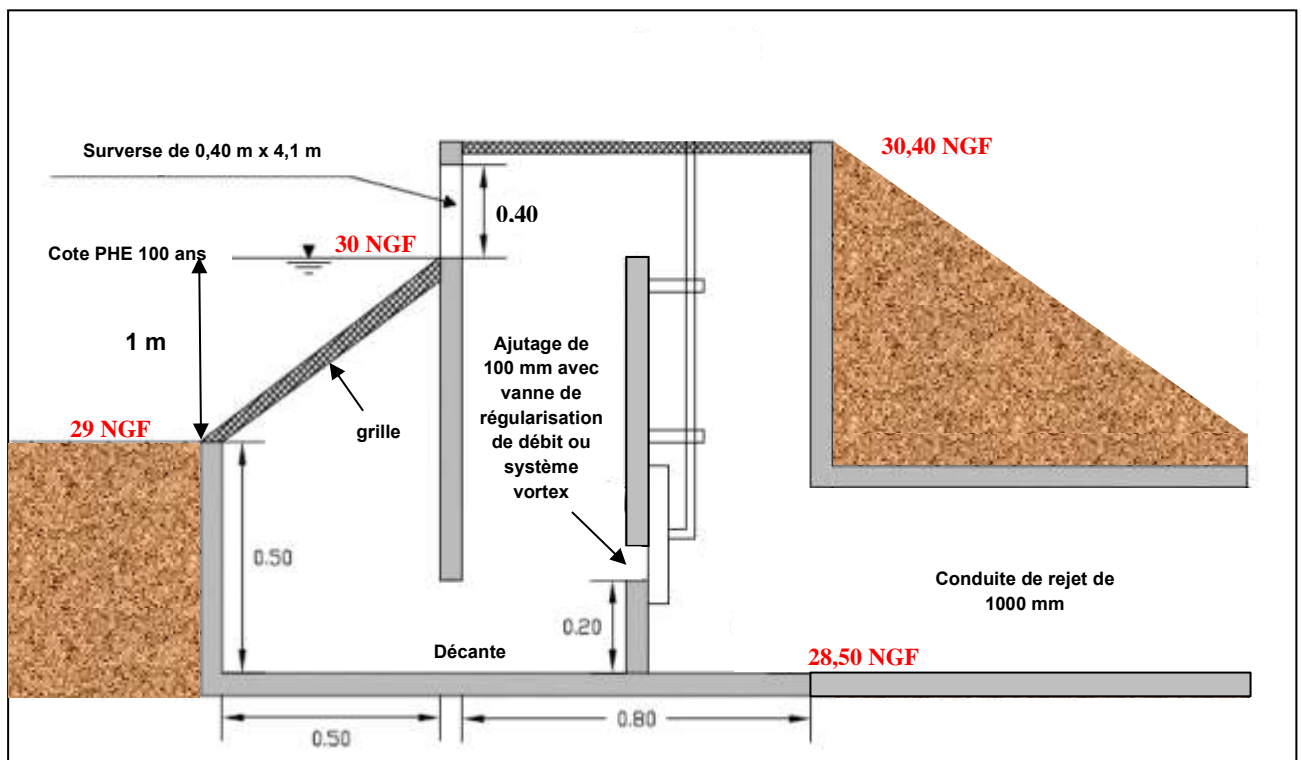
Plan de principe du bassin n°2 (vue en coupe)
